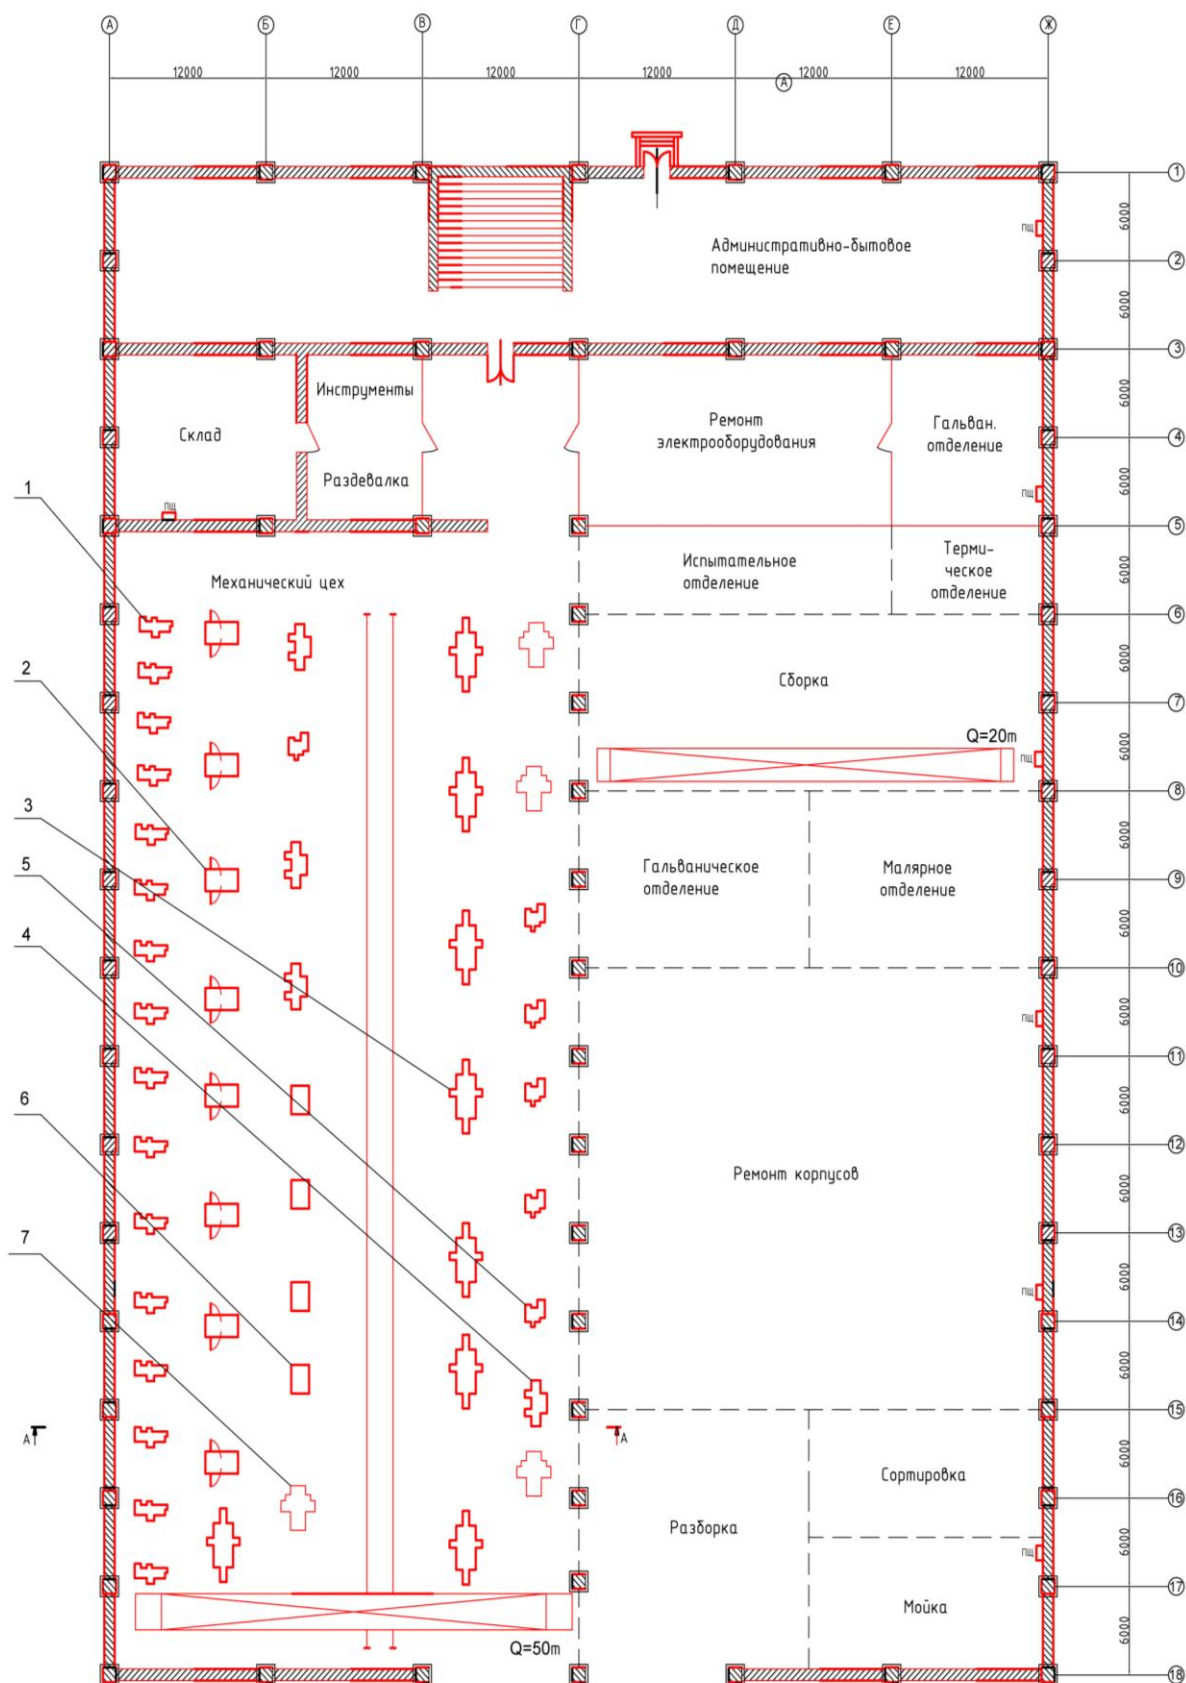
ремонтная база: 1 – токарно-винторезный 1К62; 2 – сверлильный 2А55; 3 – фрезерный А622; 4 – зуборезный 223; 5 – заточной 345А; 6 – зуборезный 5А12; 7 – строгальный 7231А.
